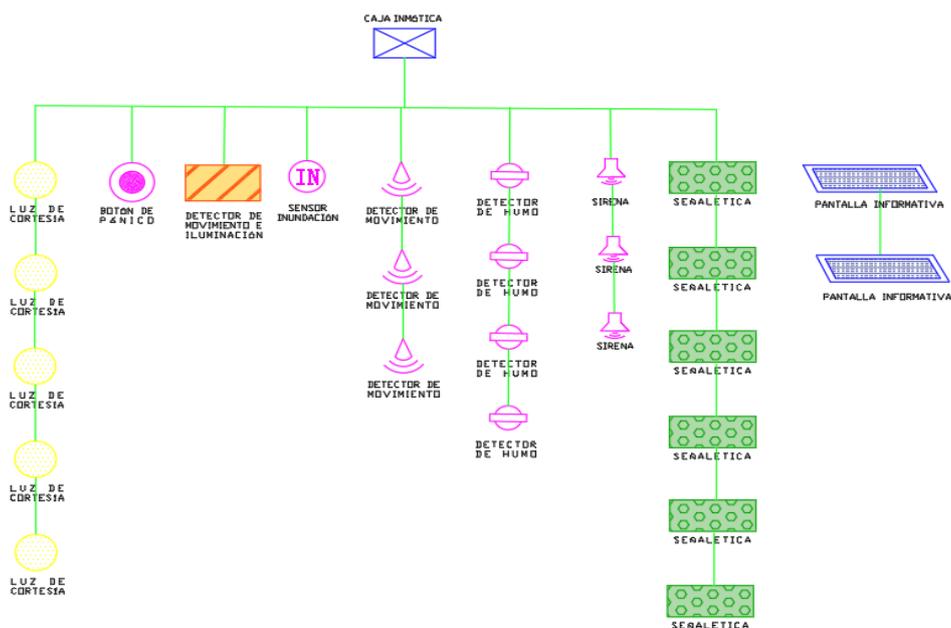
Arquitectura del sistema Inmótico de Pasillos y Escaleras Planta Baja
